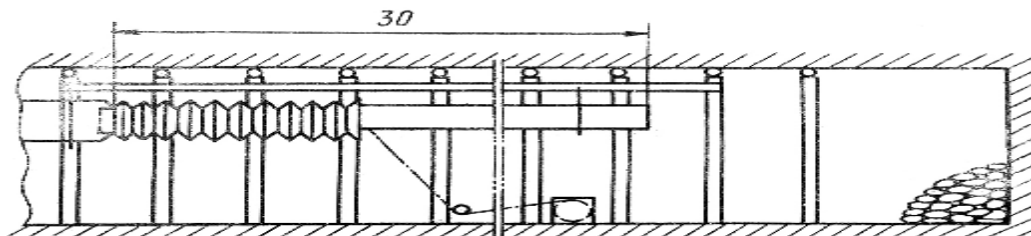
Схема раздвижного вентиляционного трубопровода.
